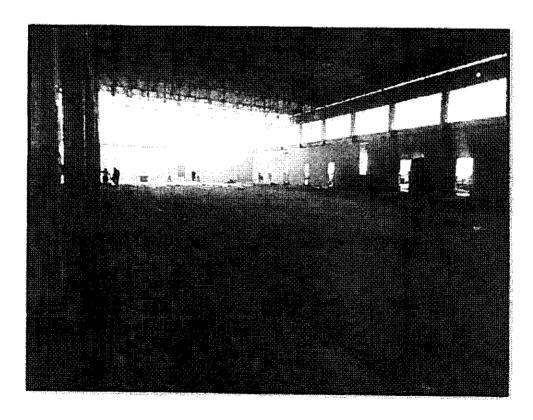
TERRENO EN IRREGULAR ESTADO DESPUES DE ELIMINACION DE LOSA, REQUIERE CAPA DE AFIRMADO PARA SUB BASE
